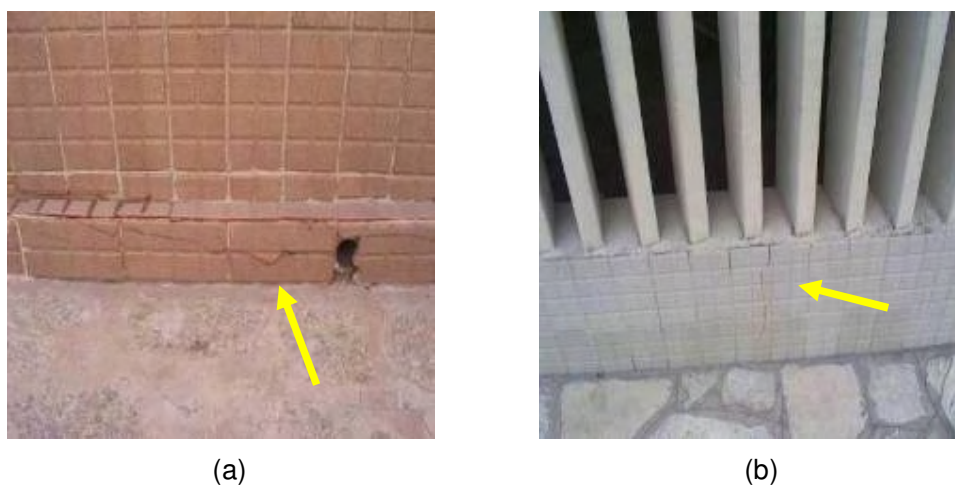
Casos de fissuras em revestimentos cerâmicos: (a) Fissura horizontal; (b) Fissura vertical.
